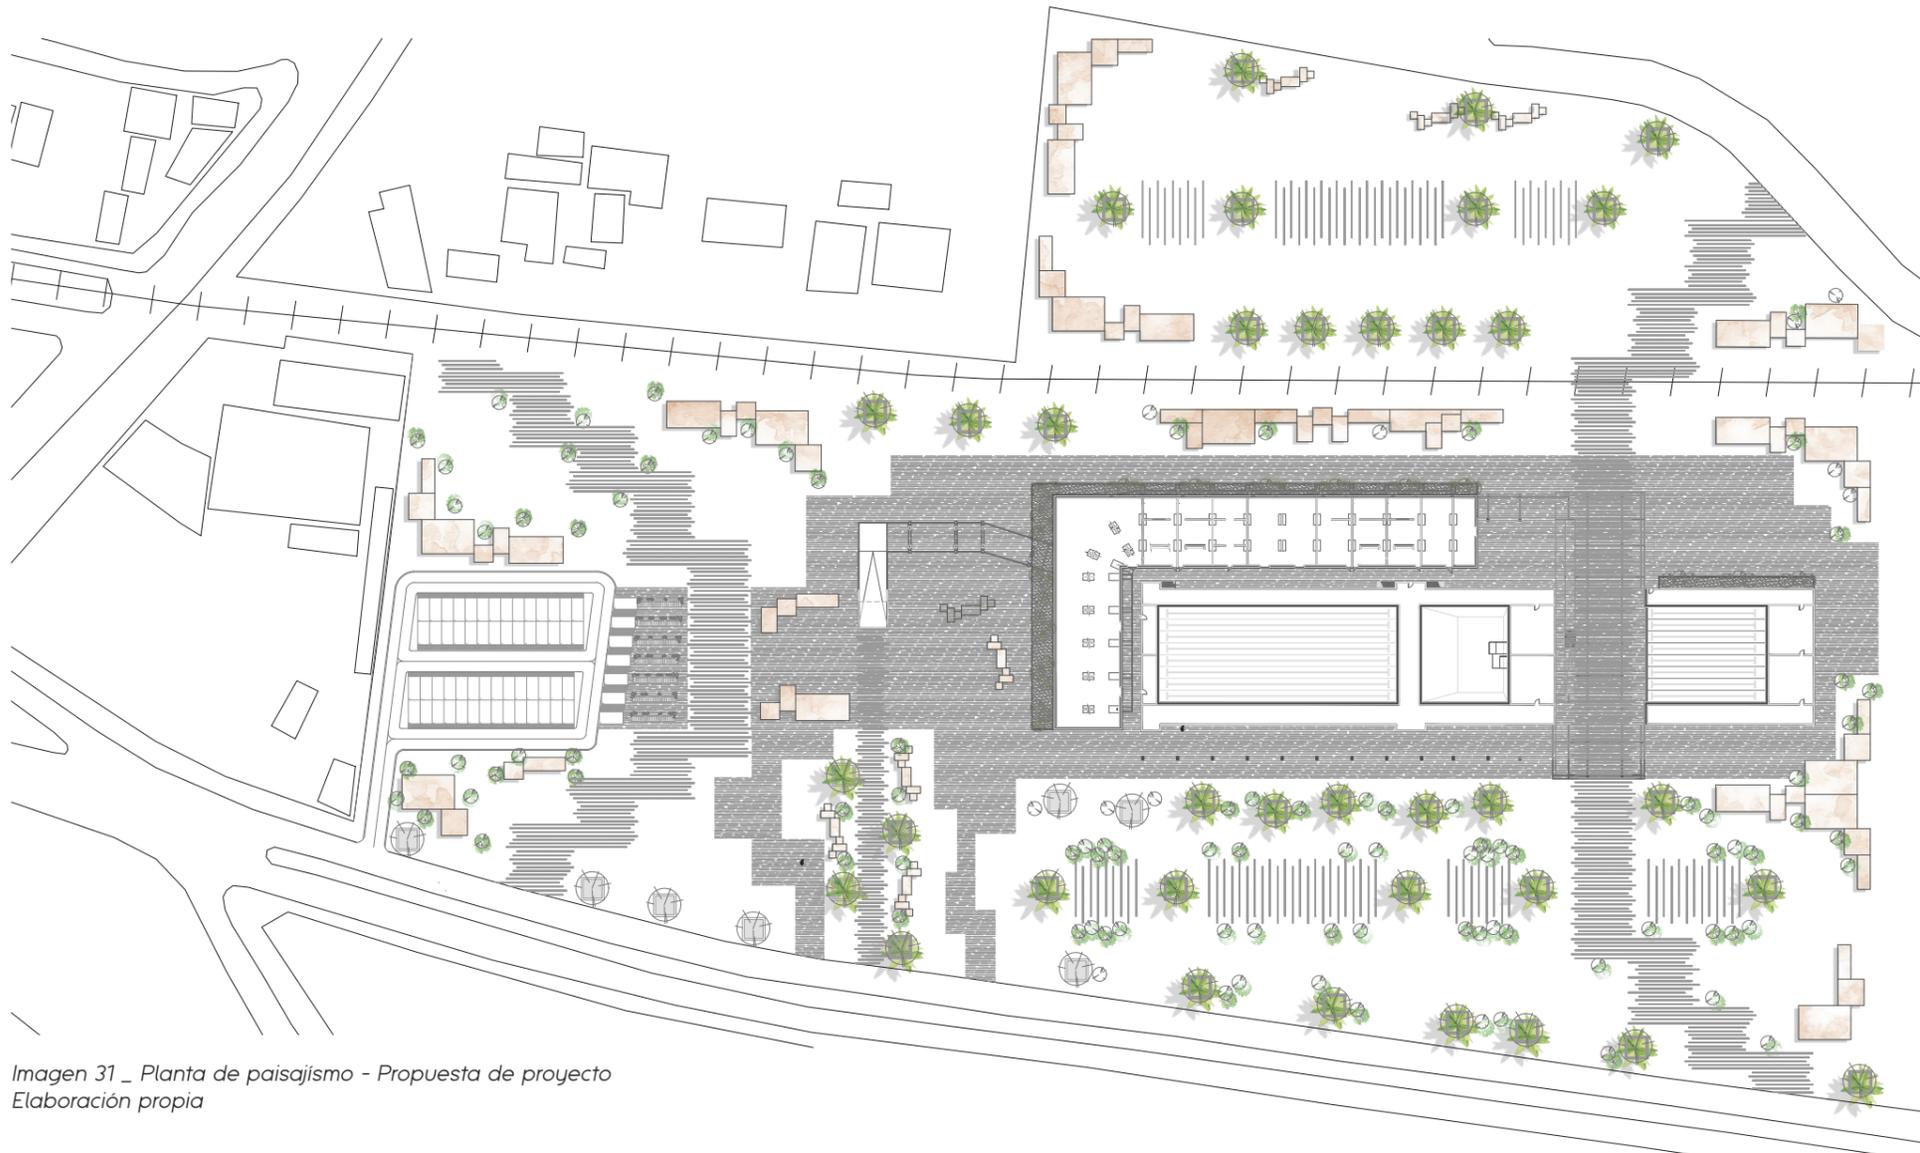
Planta de paisajismo - Propuesta de proyecto
